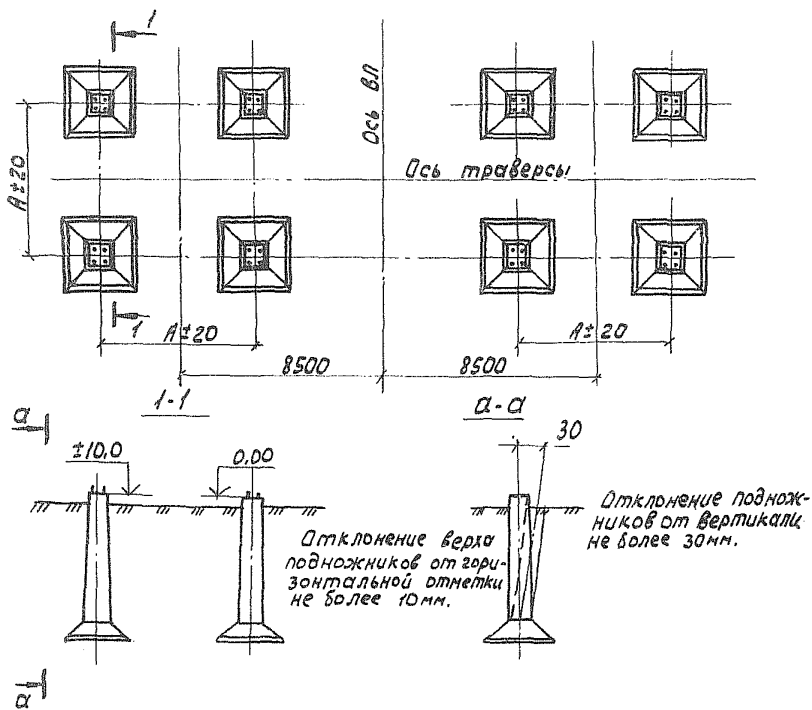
Допускаемые отклонения при монтаже фундаментов под опору типа РС 750
